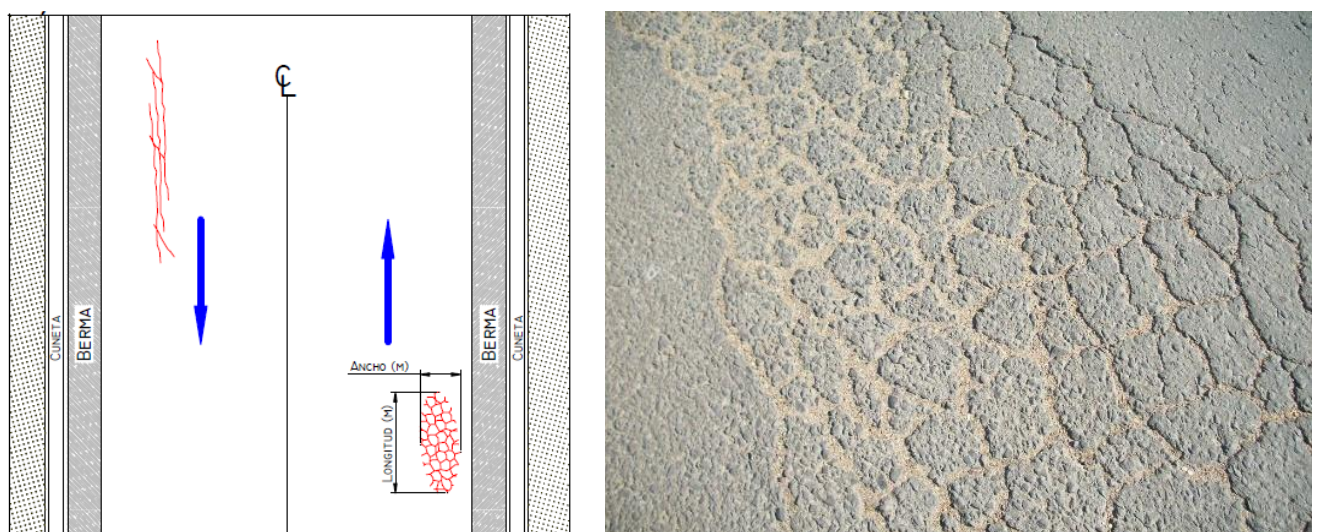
Piel de cocodrilo sobre pavimento asfáltico existente.
